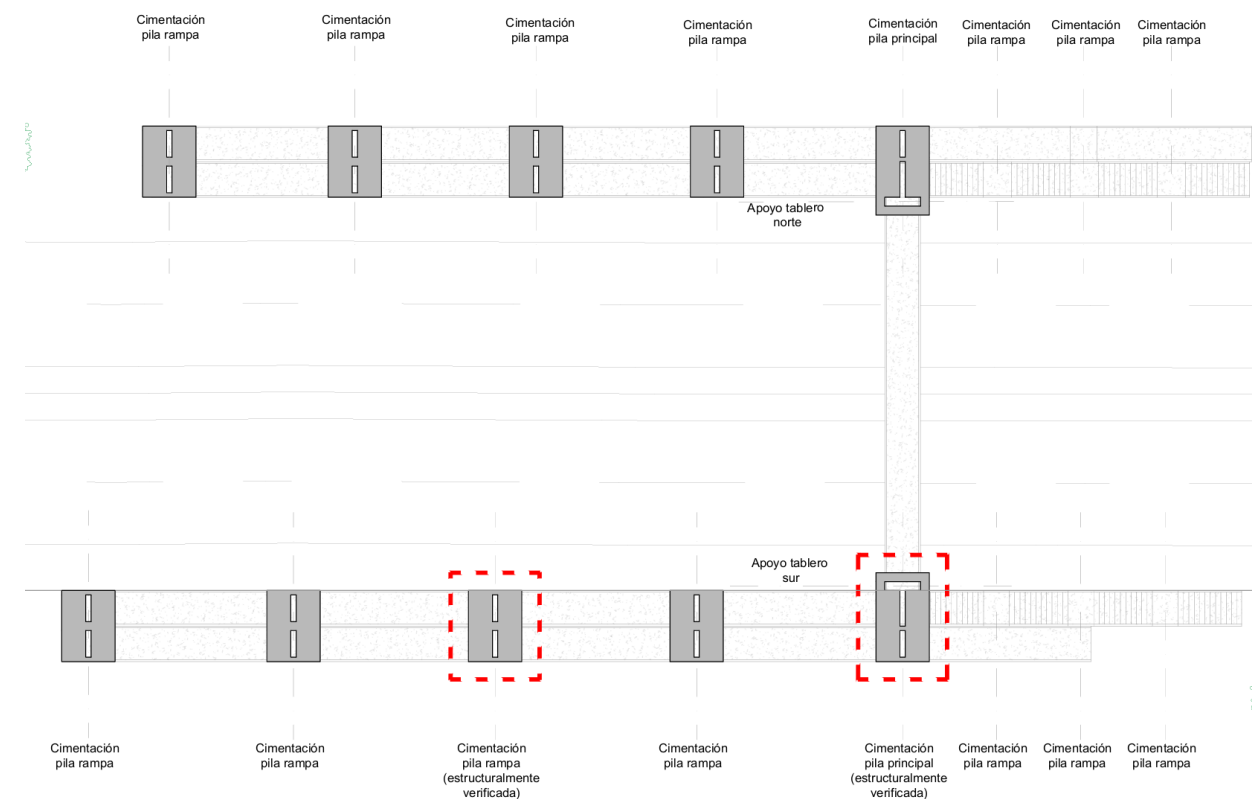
Ubicación de las zapatas diseñadas. Fuente: Elaboración propia.
